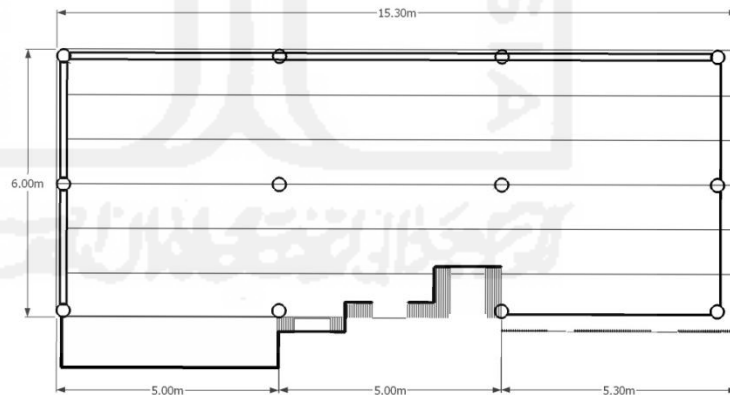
Gambar tampak dan denah bangunan mini gallery
